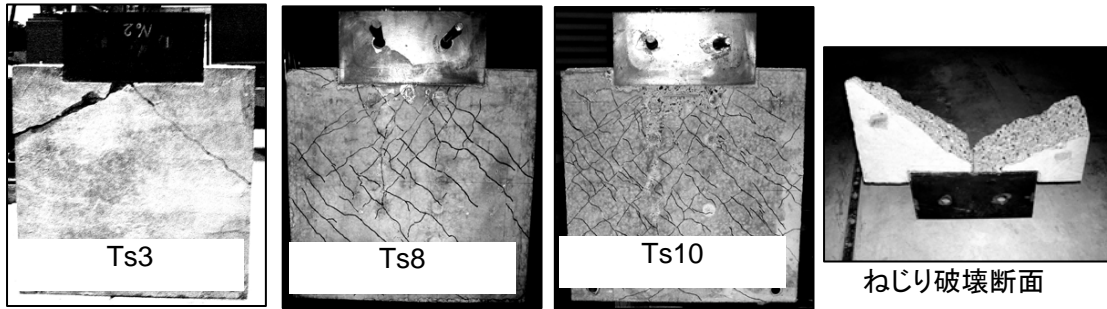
ひび割れ状況 (Ts I シリーズ)
